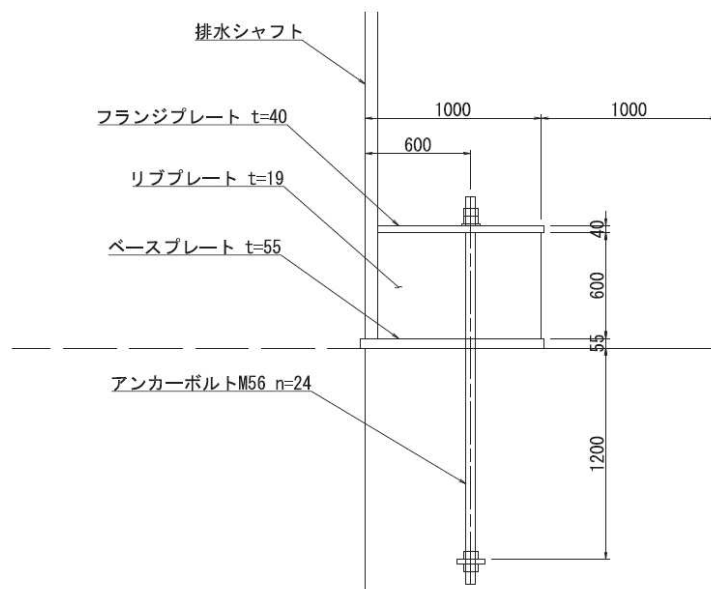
(2) 接合部の構造概要 No.2 揚水井戸 (単位: mm)
